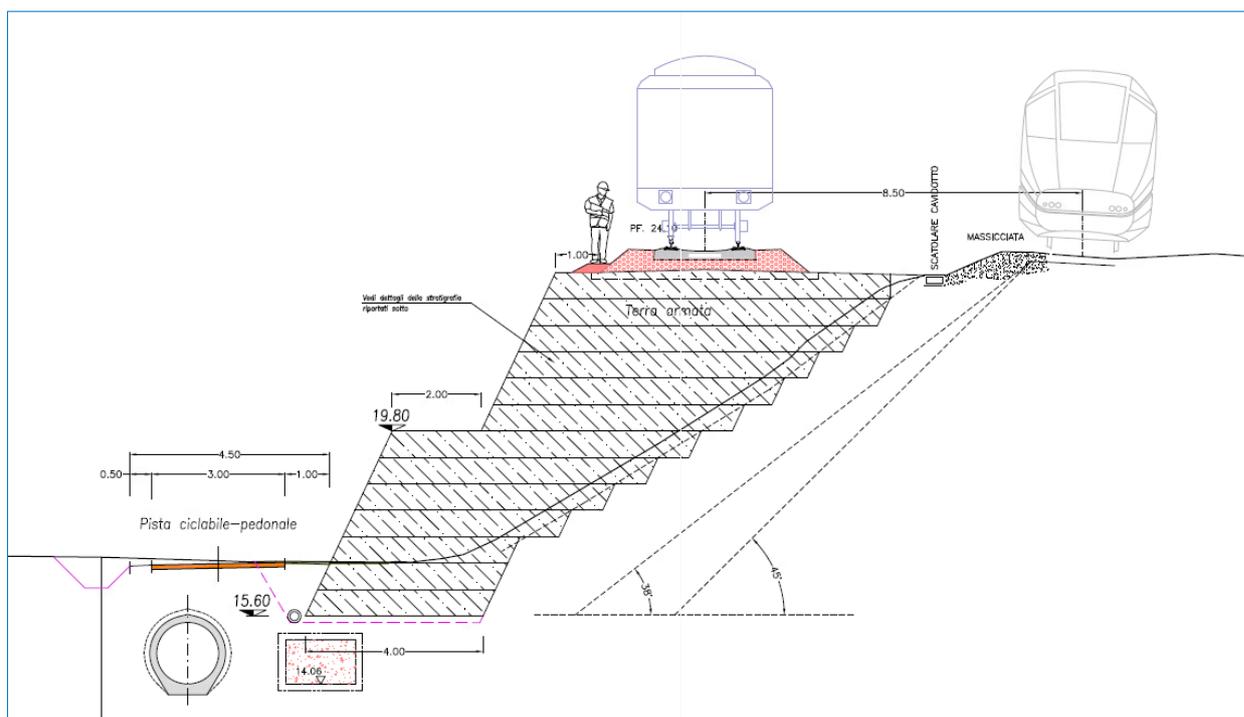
Sezione tipo dell'allargamento del rilevato FS esistente (cfr. tav. 8, allungamento asta di manovra, opere civili).
